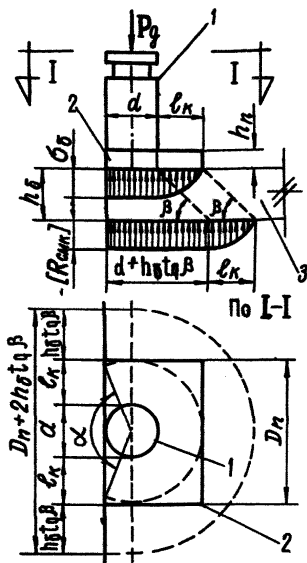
Y.7. Расчетная схема стальной опорной плиты на двухслойном основании при расположении домкрата у края стены:
